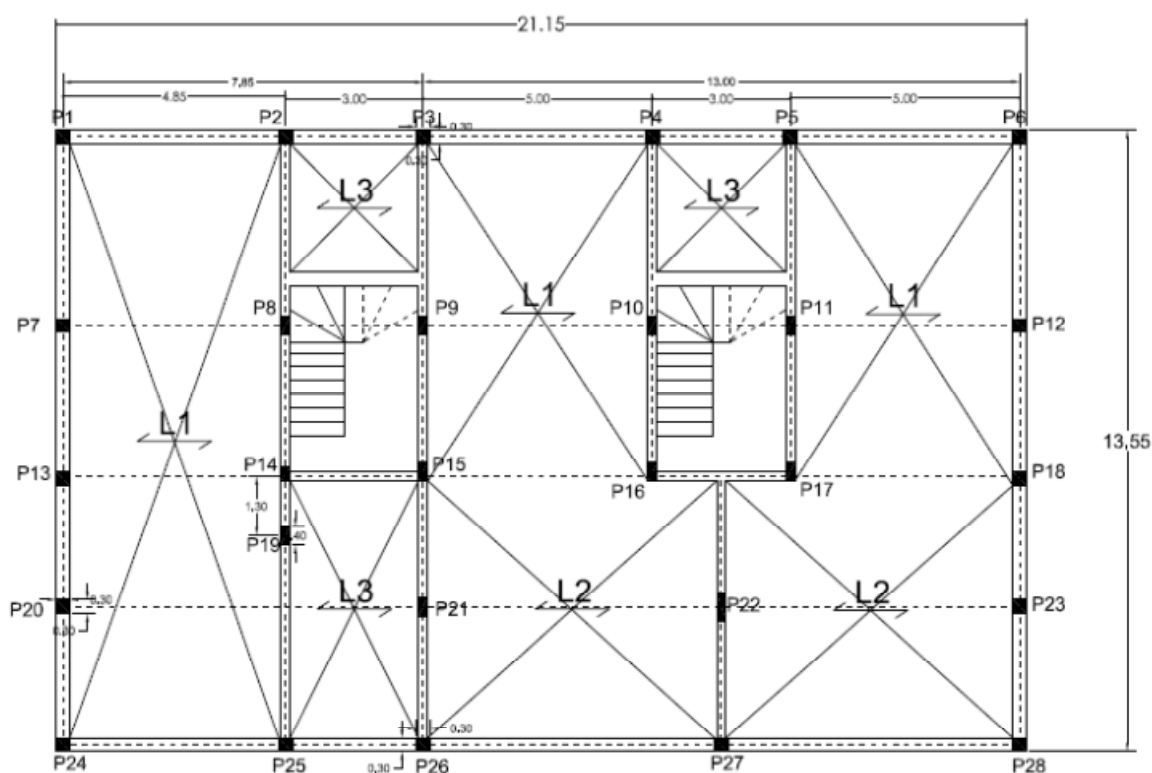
Planta Estrutural “Edifício Maia”
